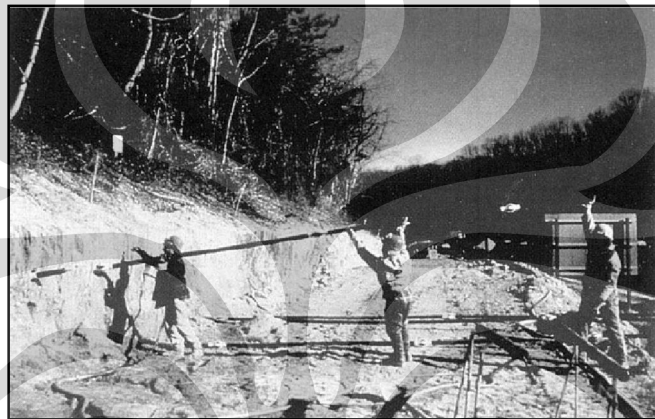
Metode Konstruksi Soil Nail Wall
